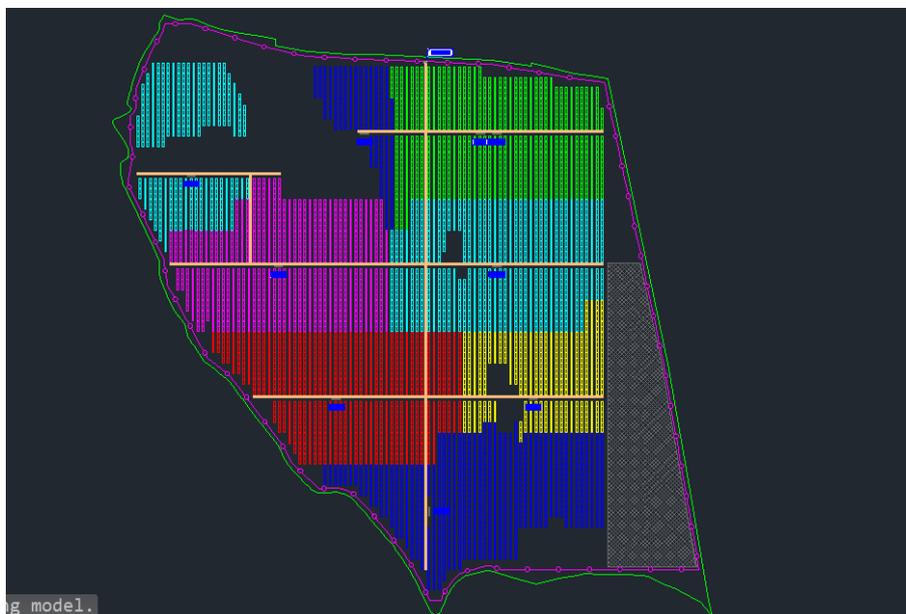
Layout .dwg de la implantación de la planta solar fotovoltaica
